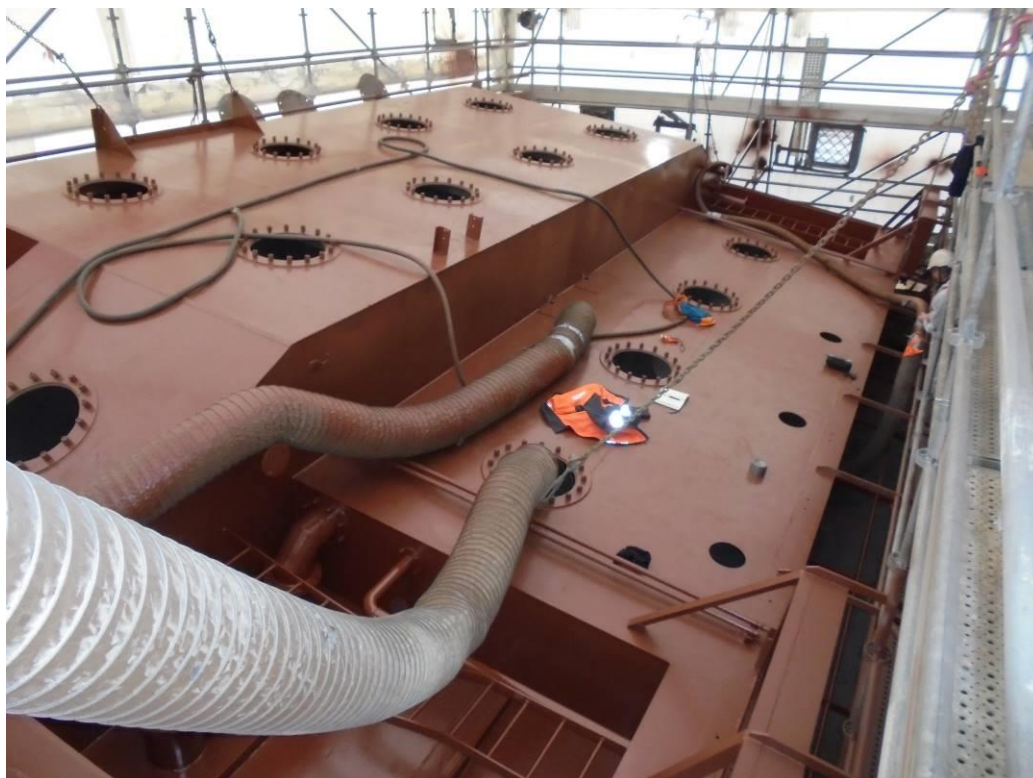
intérieur du confinement après la fin du désamiantage et l'application de la première couche de revêtement
